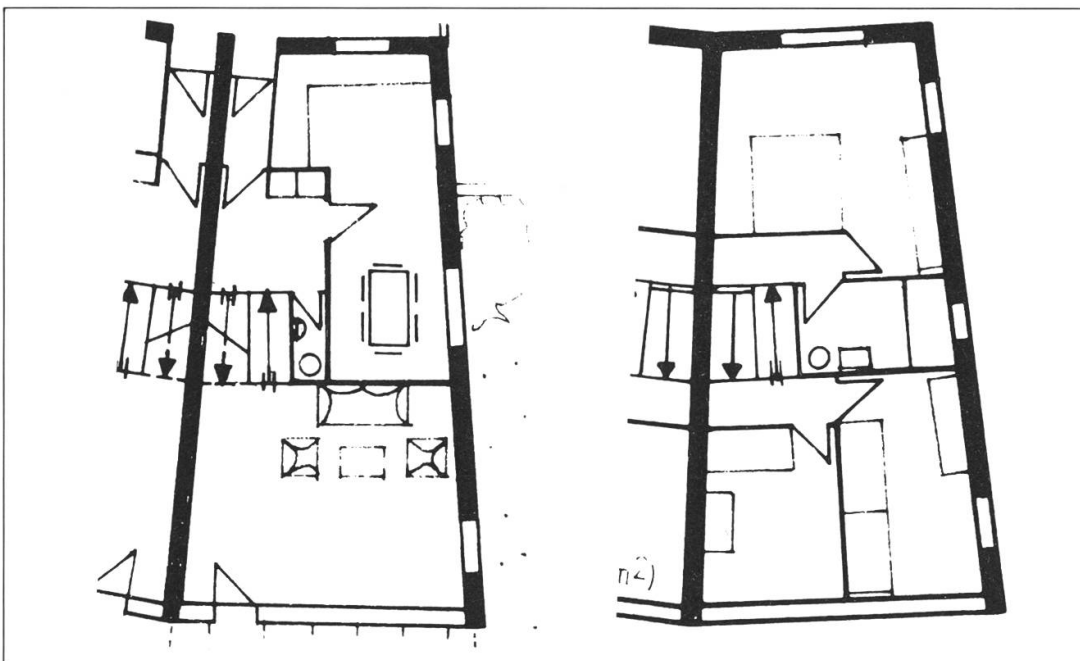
5-Zimmer-Reihenhaustyp laut Vorprojekt mit 119 m² (halbgesschossig versetzt) (Siehe Abb. 2:④)
